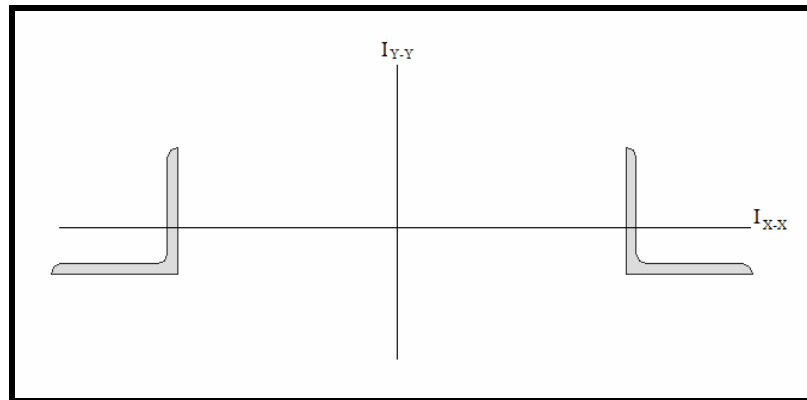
Se observa un corte transversal de una de las columnas transversales
